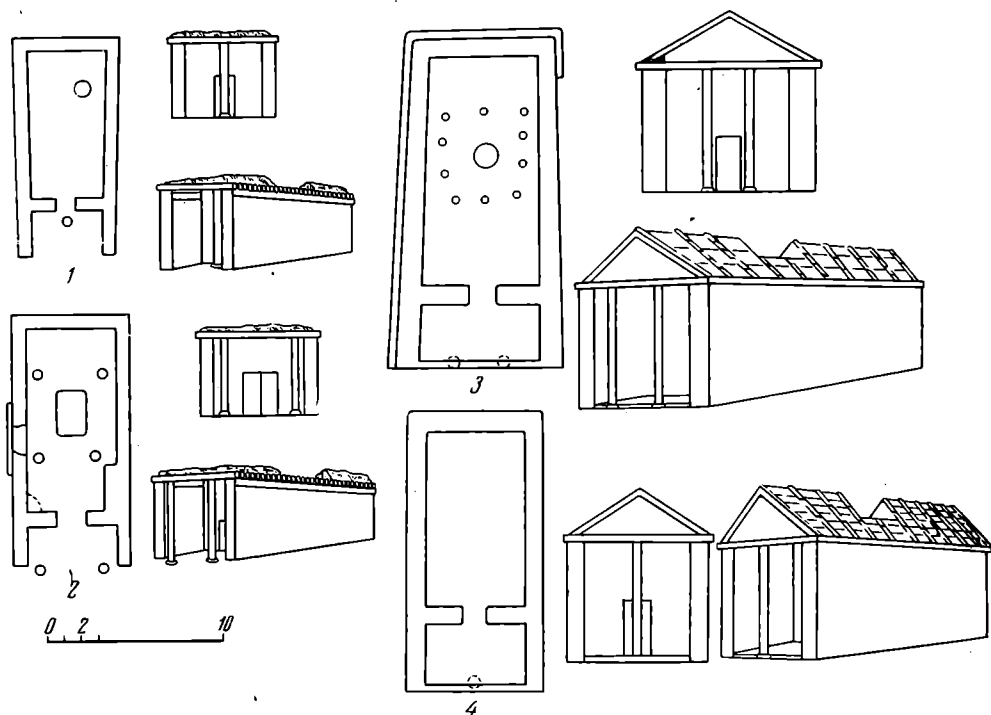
Культовые здания Неаполя скифского (планы и реконструкции): 1 — здание «З»; 2 — здание «Е»; 3 — здание «А»; 4 — здание «В»
